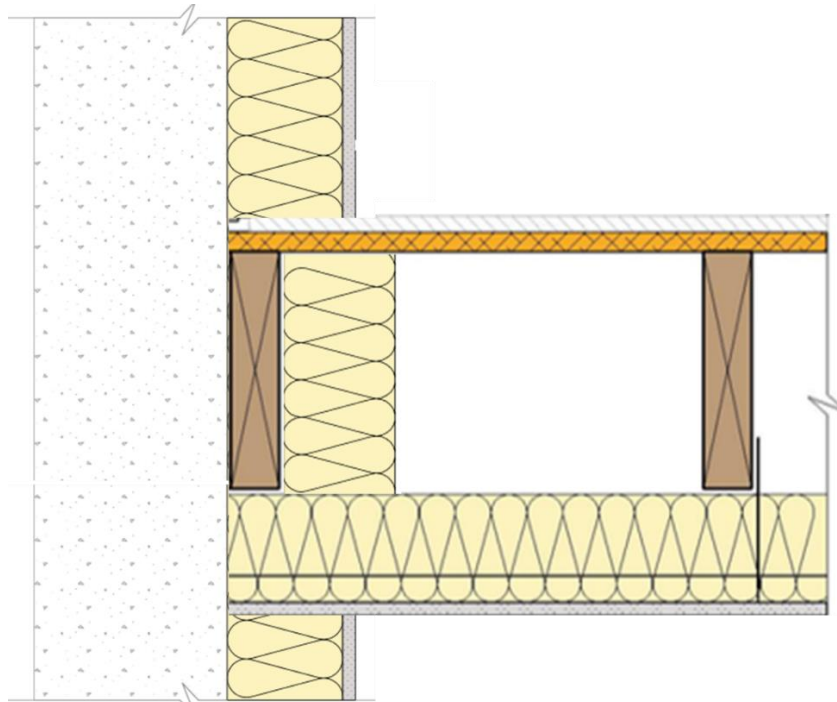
Liaison sur muraille sur mur béton isolé par l'intérieur
